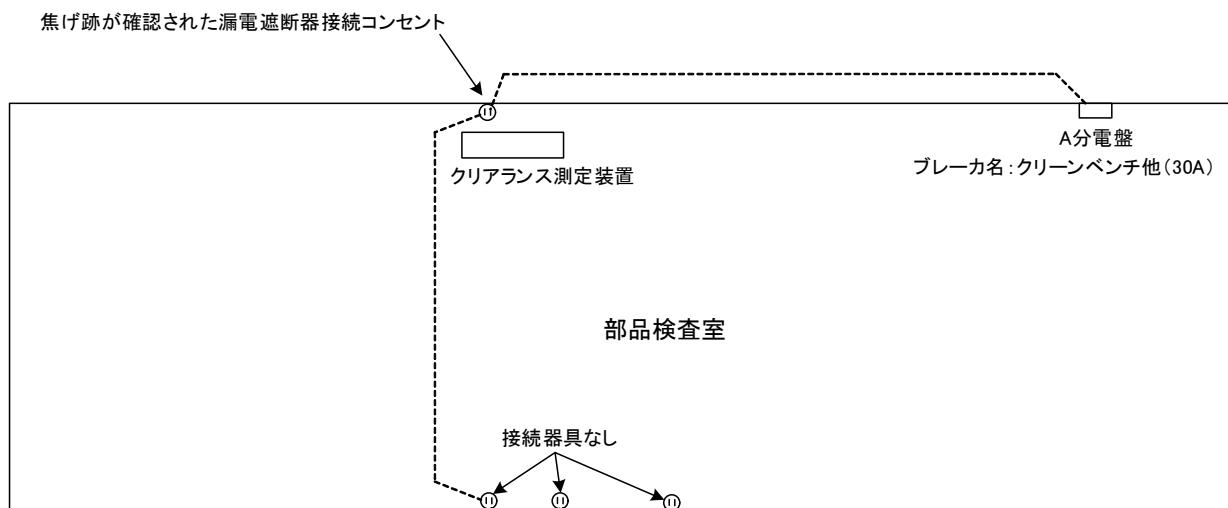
濃縮工学施設 OP-1 主棟 1 階 平面図
